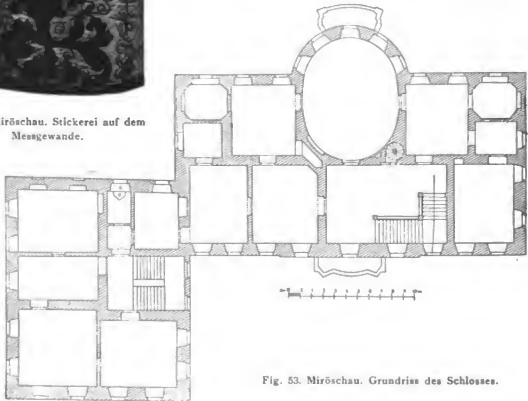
Miröschau. Grundriss des Schlosses.
